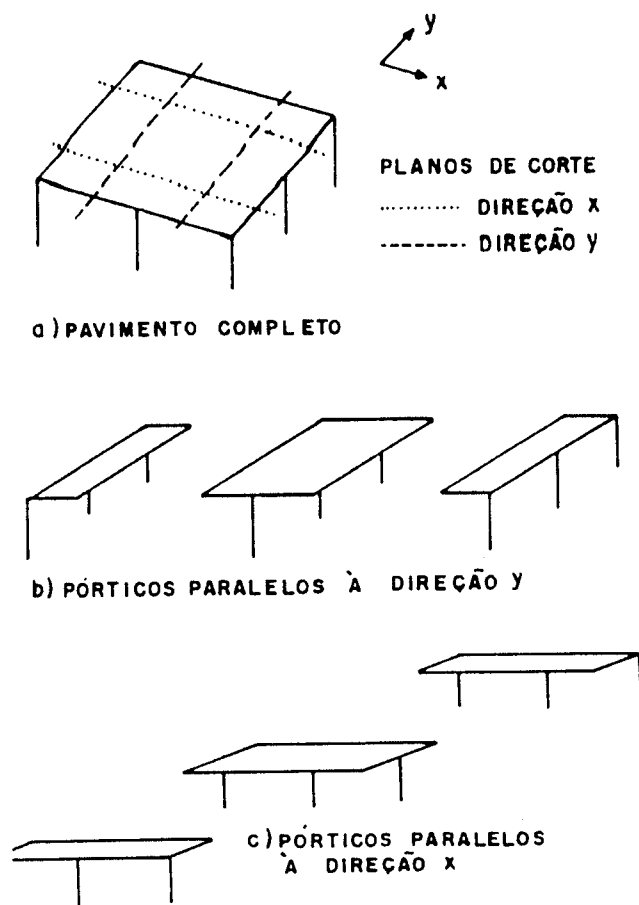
Divisão de um pavimento em pórticos paralelos às direções x e y
